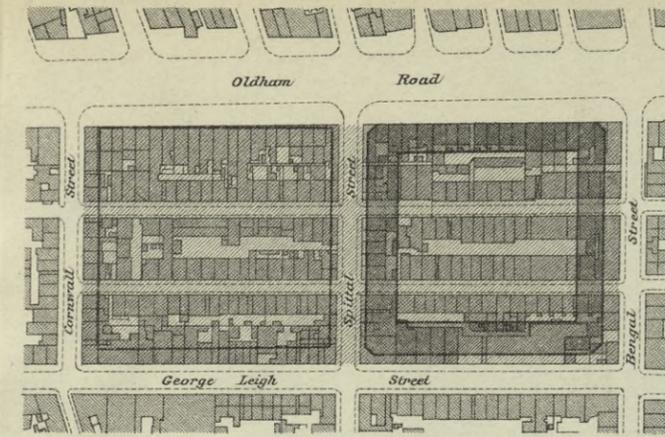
Sanierungsprojekt Oldham Road in Manchester.
